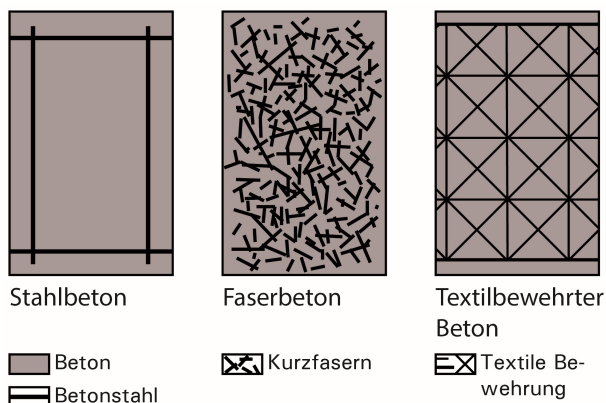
Schematische Darstellung unterschiedlicher Bewehrungssysteme für Beton [129]
